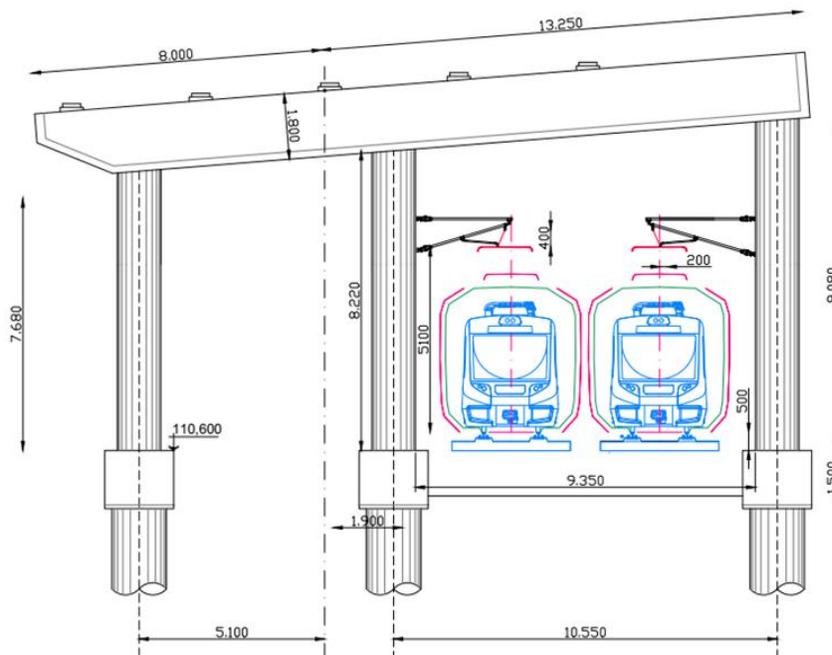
Pila P-02 con tren ligero y sus respectivos gálibos
